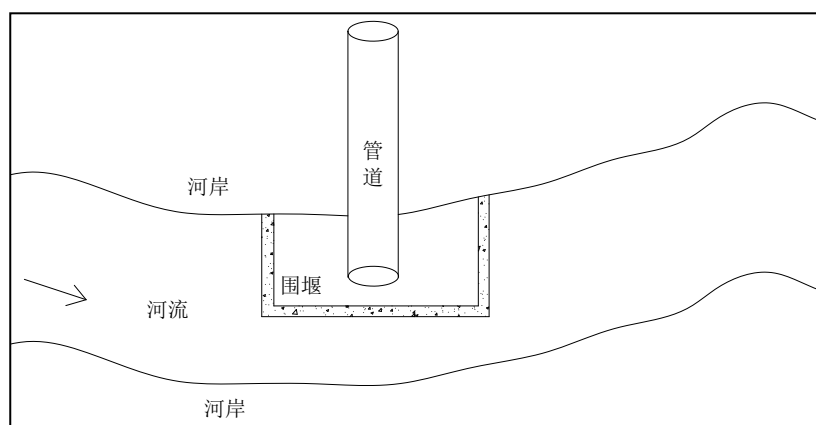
围堰导流开挖管沟法施工断面示意图
